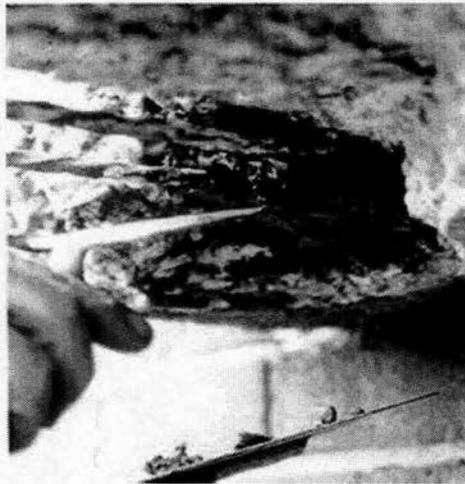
Aplicación del mortero polimérico de base cemento (de baja contracción):
